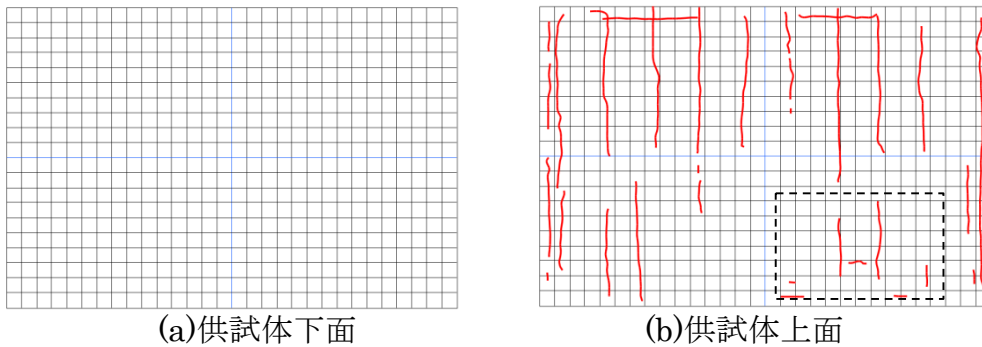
腐食ひび割れ発生状況(散布供試体)
